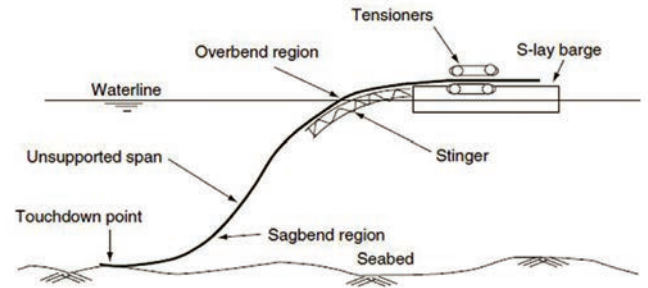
Схема прокладки подводного трубопровода методом S-lay
